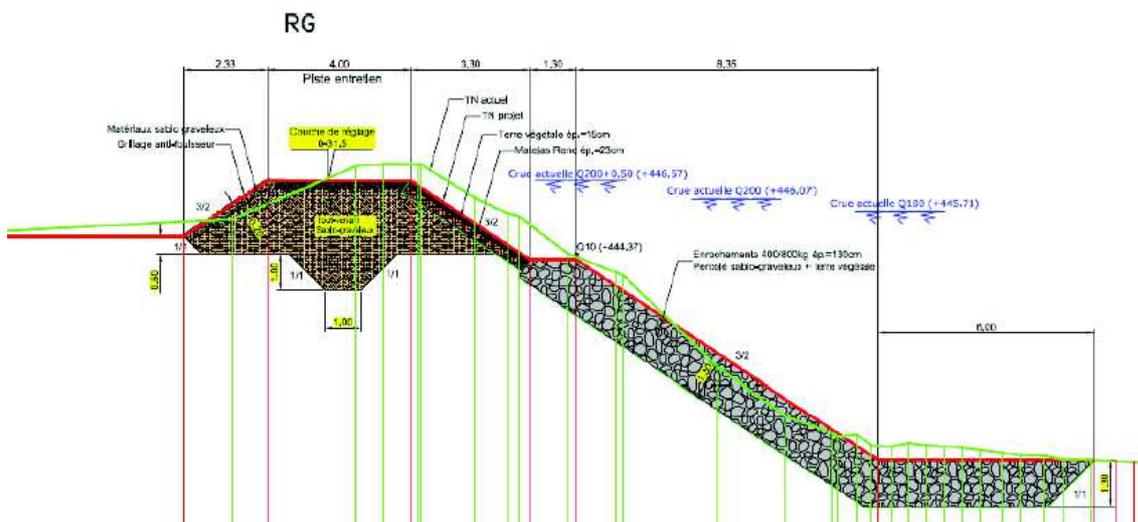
Arve RG : Profil type : Reconstruction complète du corps de digue
